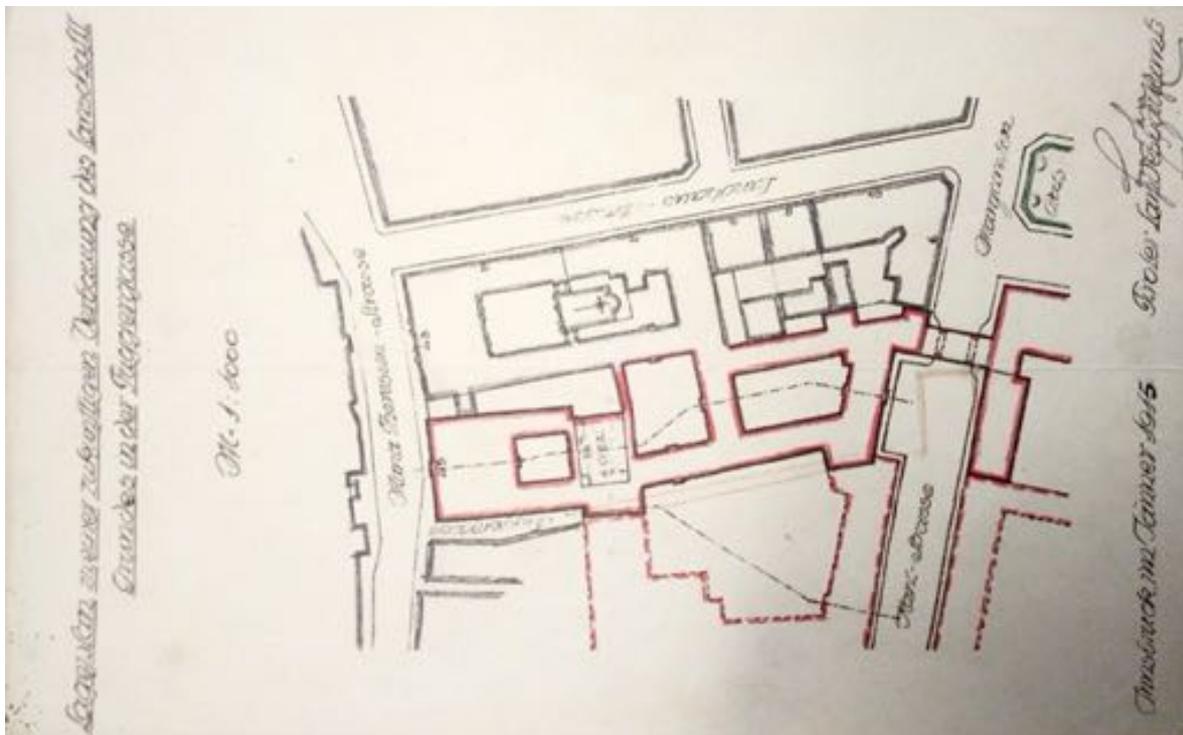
, Lageplan zu einer zukünftigen Verbauung des landschaftlichen Grundes in der Fuggergasse, Tiroler Landesbauamt, Jänner 1915. Auch die ersten Pläne für eine Erweiterung des Landhauses sahen einen Vorplatz vor (gestrichelte, rote Linie) und eine Bebauung mit zwei Innenhöfen (StAI, Abteilung VI, Akten/Pläne-Bebauung, Karton 1, Mappe Alte Bebauungspläne, Fuggergasse; genordet und daher gedreht).
